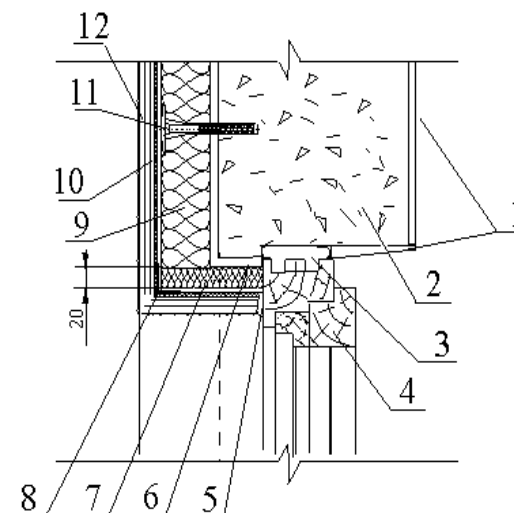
Фрагмент утепления верхнего горизонтального откоса оконного проема.
